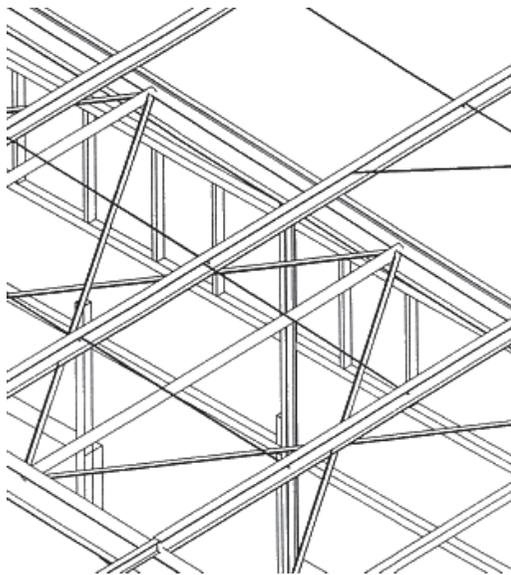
Wohngebäude in Berlin, Kaden Klingbeil Architekten
